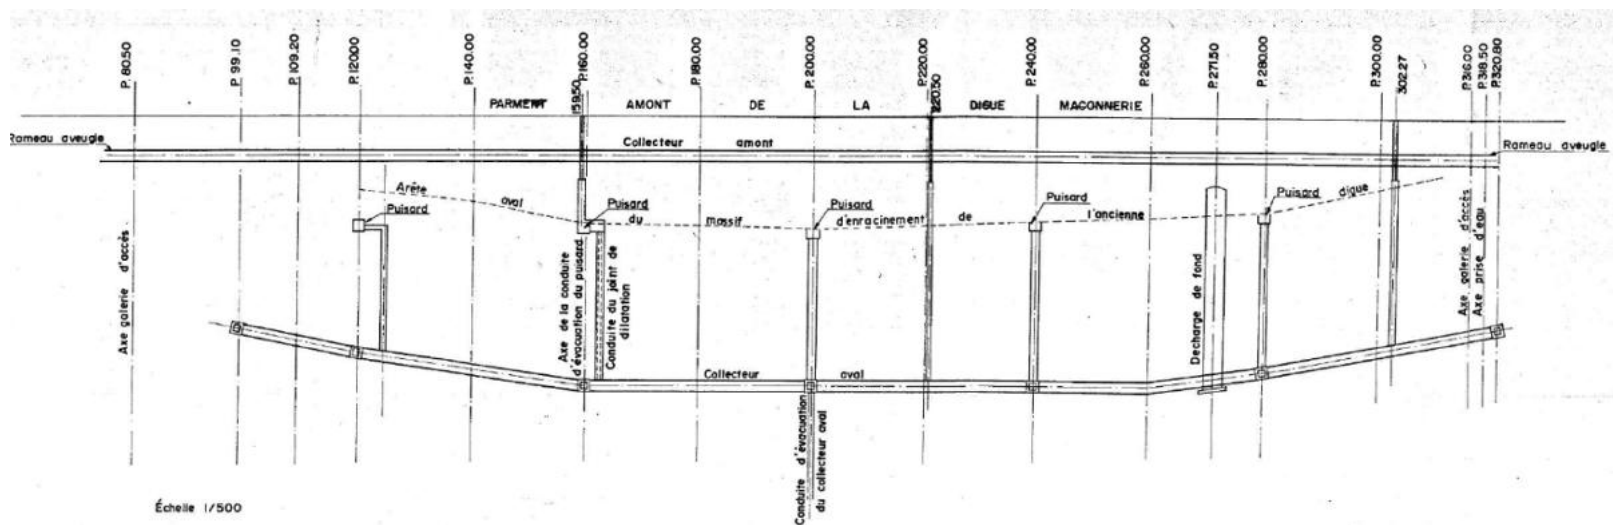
Schéma vue en plan du réseau de drainage avant les travaux de 2022-2024 (galerie amont, puisard et joint de dilatation, galerie aval, conduite exutoire de la galerie aval vers l'Avière)
